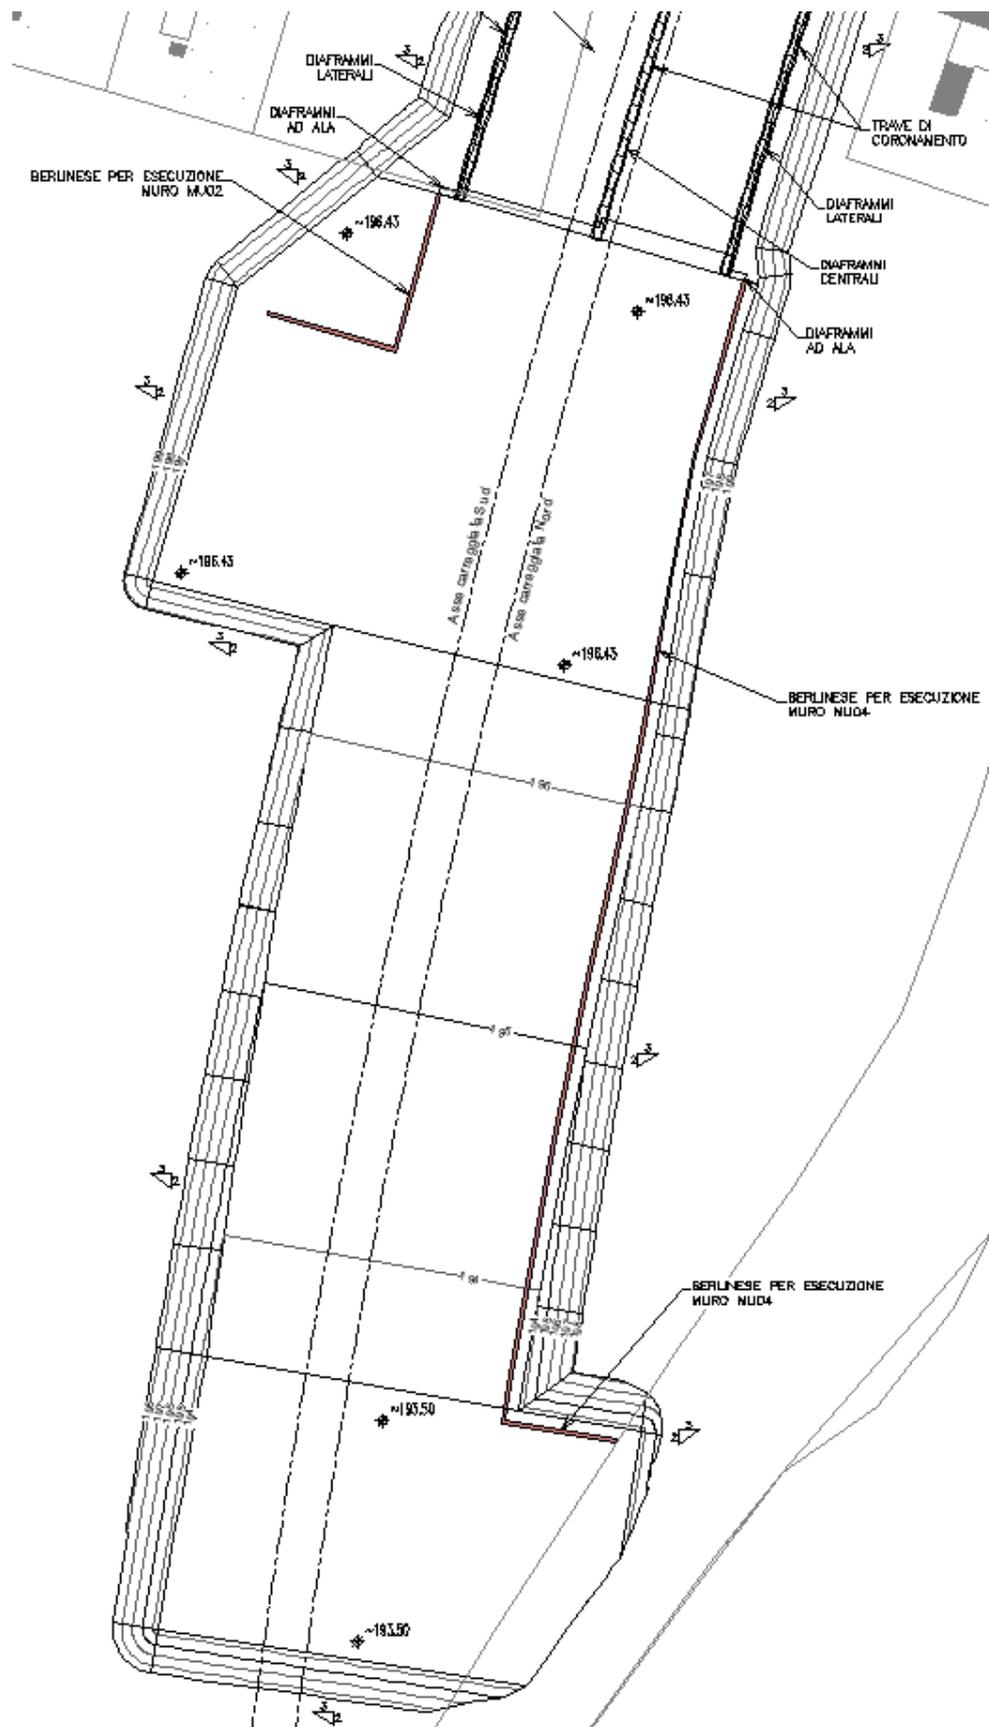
Planimetria berlinese/diaframmi ad ala - Sud
